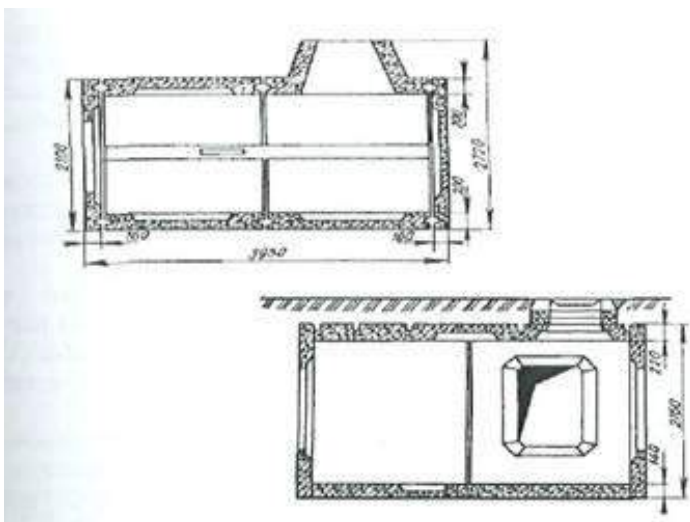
Угловой сборный железобетонный колодец специального типа ККСу-1.
